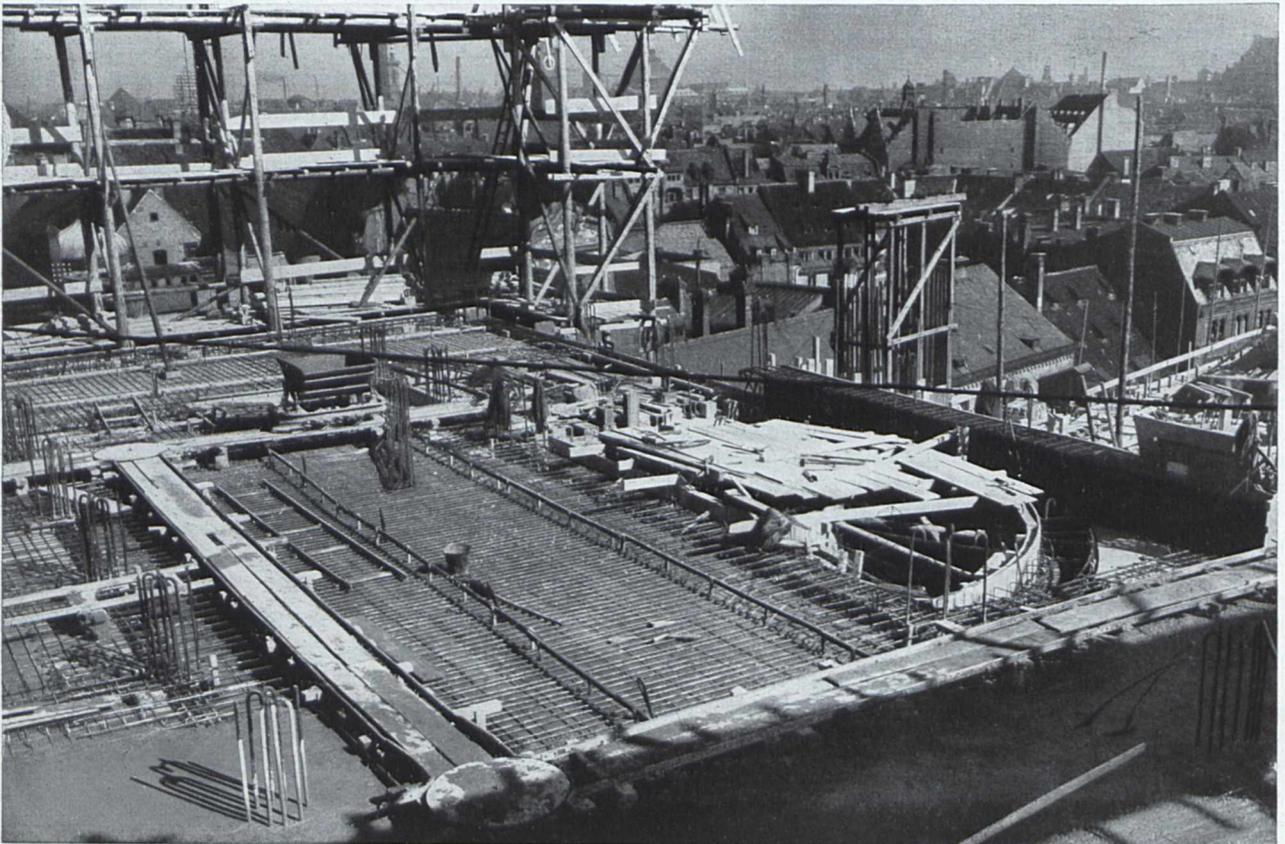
Bauausführung: Karl Stöhr, Bauunternehmung, München, Schwanthalerstraße 11
